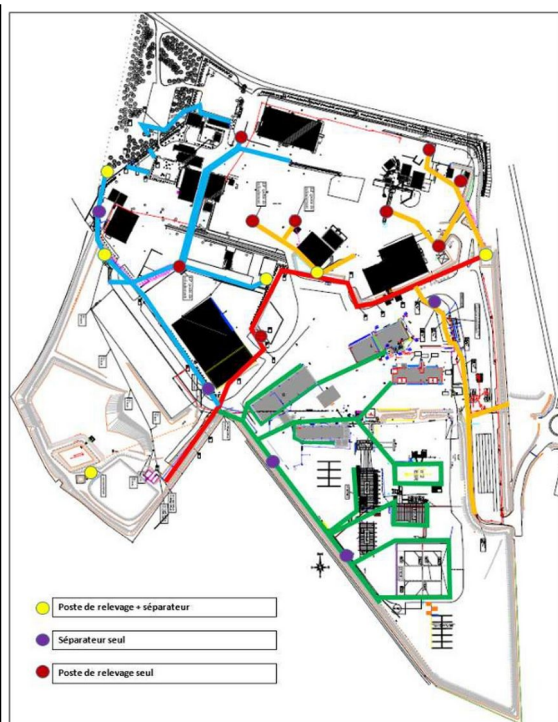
plan du réseau des eaux pluviales sur site (p 251 – EI)
